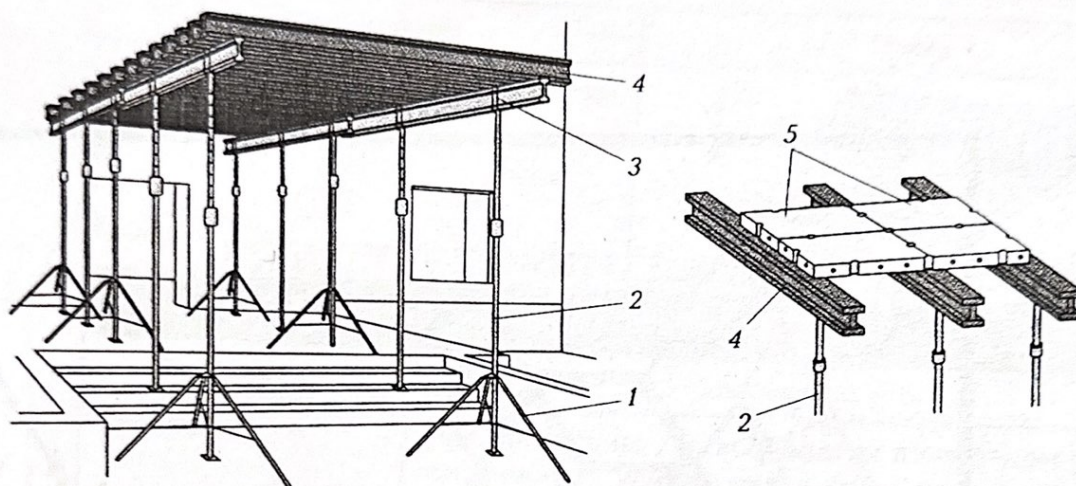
Конструкция опалубки для монолитного перекрытия:
